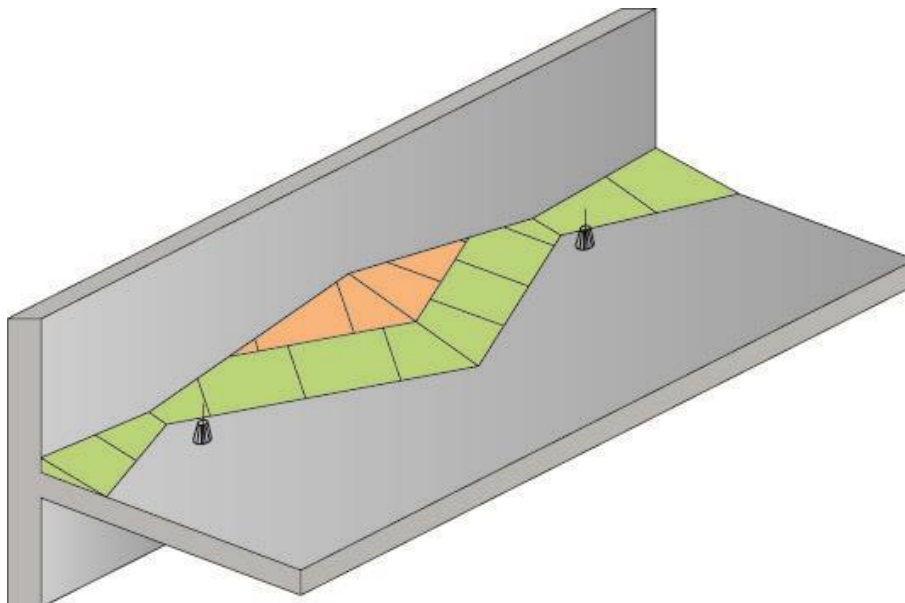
Схема раскладки плит PIR SLOPE 3,4% при устройстве контруклона в парапетной зоне
